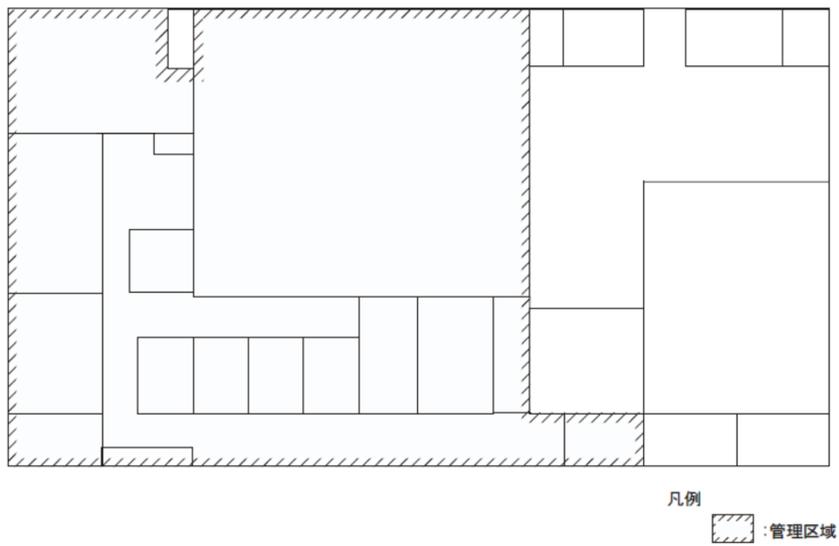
プルトニウム廃棄物処理開発施設2階平面図
